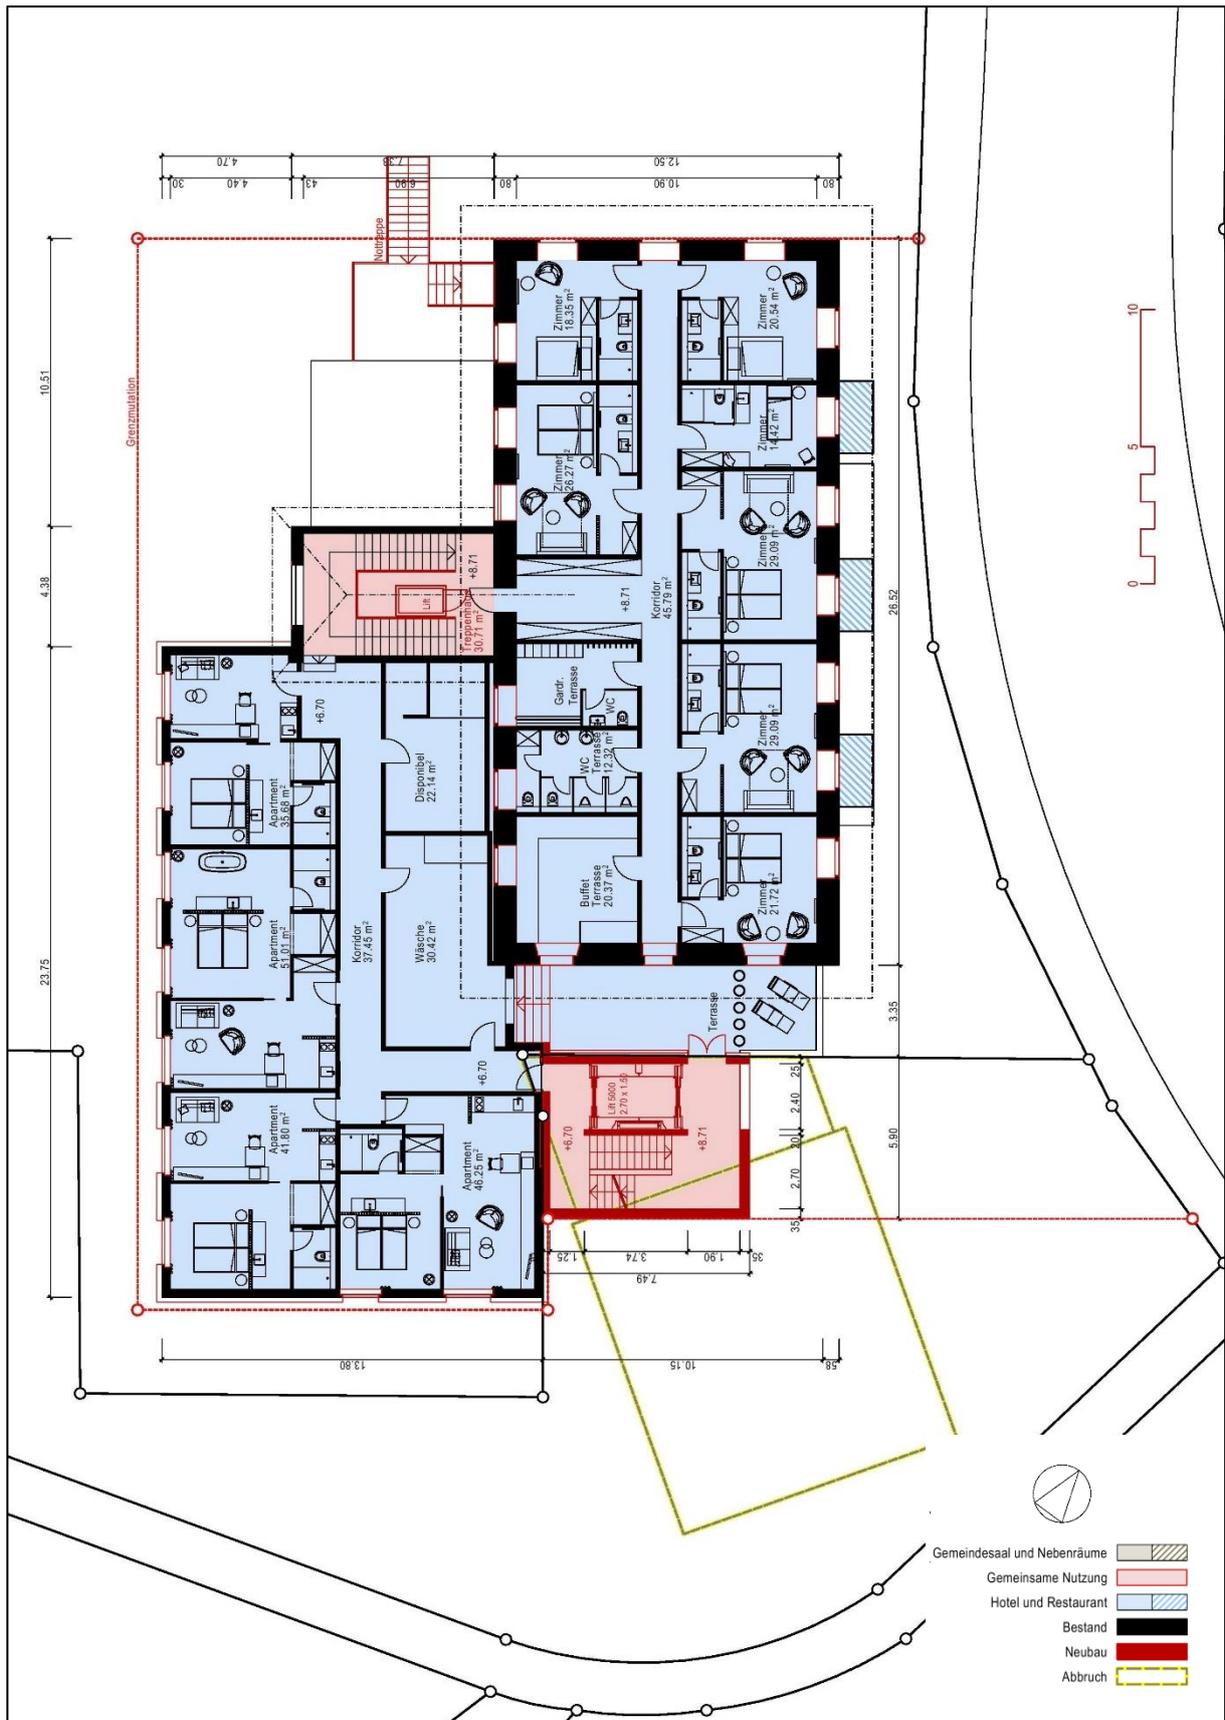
Grundriss 2. Obergeschoss, mit Distanzangabe, Stand: 3.11.2022
